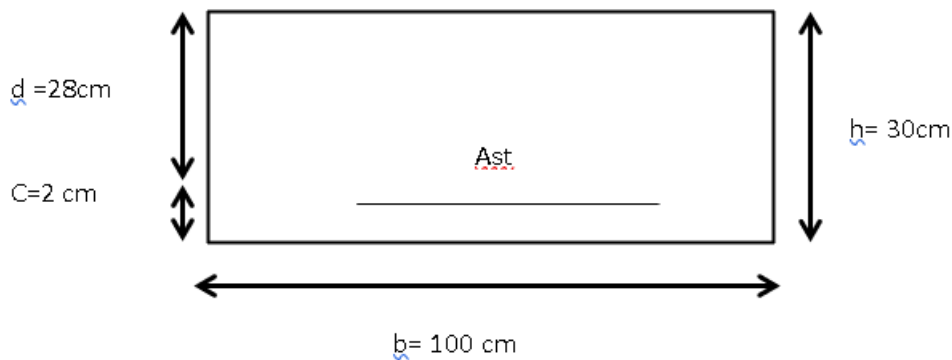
Schéma statique de ferrailage du mur plaque
